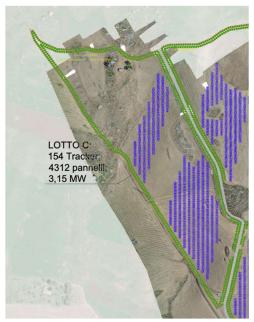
Particolare Layout di impianto area C su stralcio rilievo
